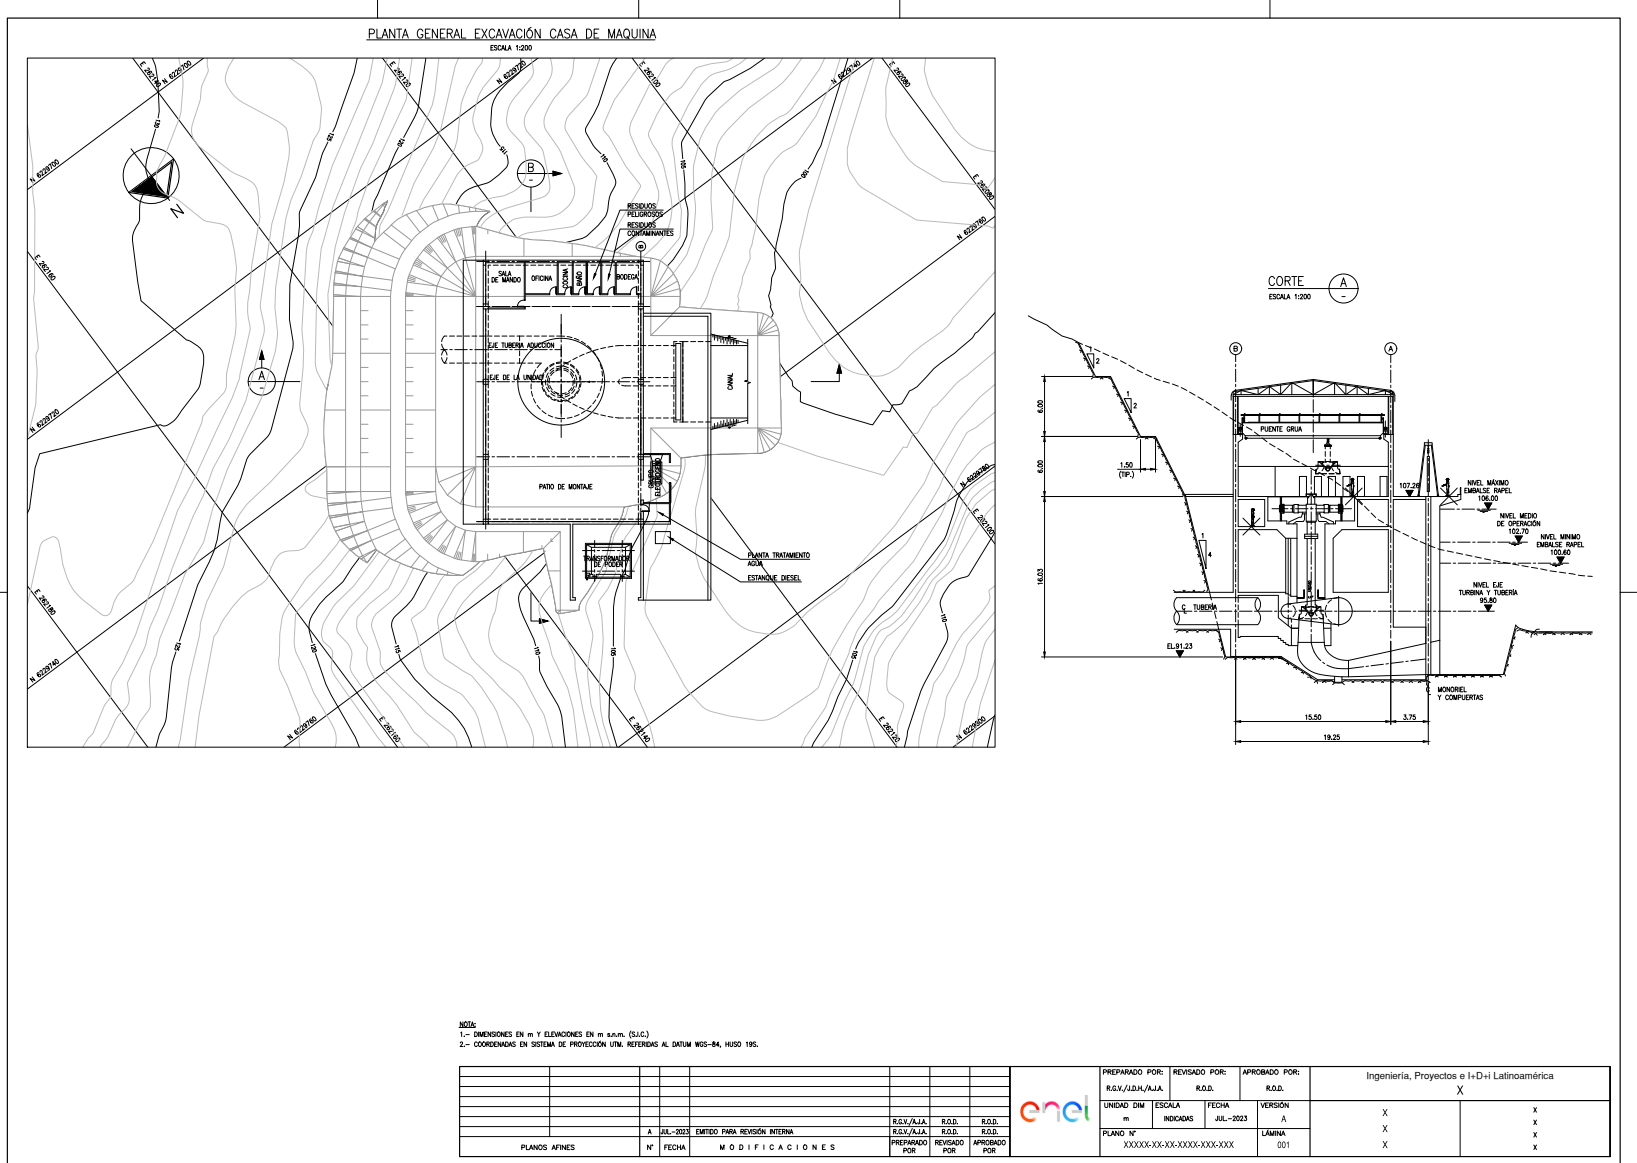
Planta general casa de máquinas. Fuente: Guzmán Vargas, R.
